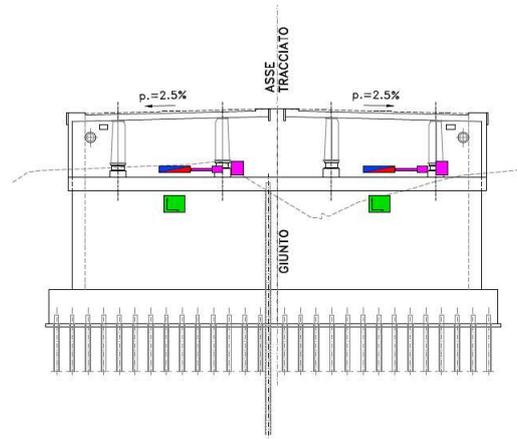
Schema posizionamento strumentazioni spalla ponti e viadotti
